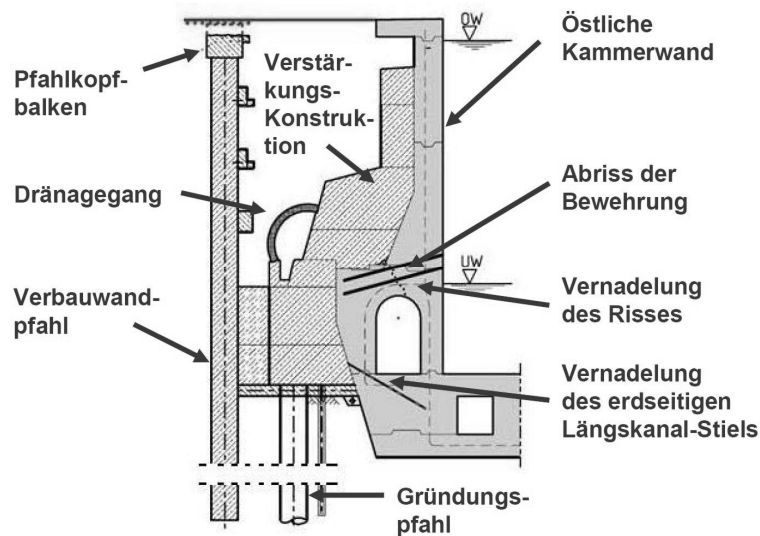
Stahlbeton-Verstärkungsstruktur der östlichen Kammerwand
